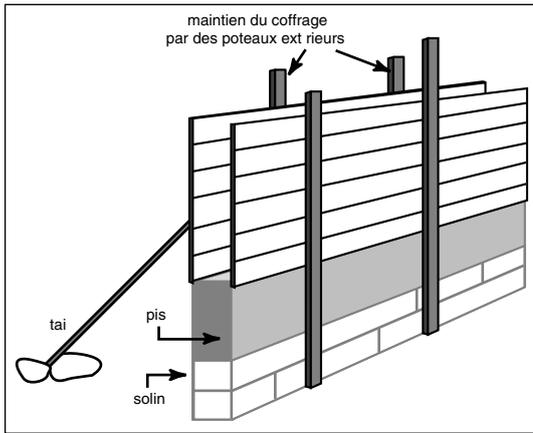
Restitution d'un type de coffrage maintenu extérieurement par des poteaux au lieu de clés transversales. Ce mode de construction produit des murs en pisé d'apparence continue de bas en haut et sur toute la longueur.
